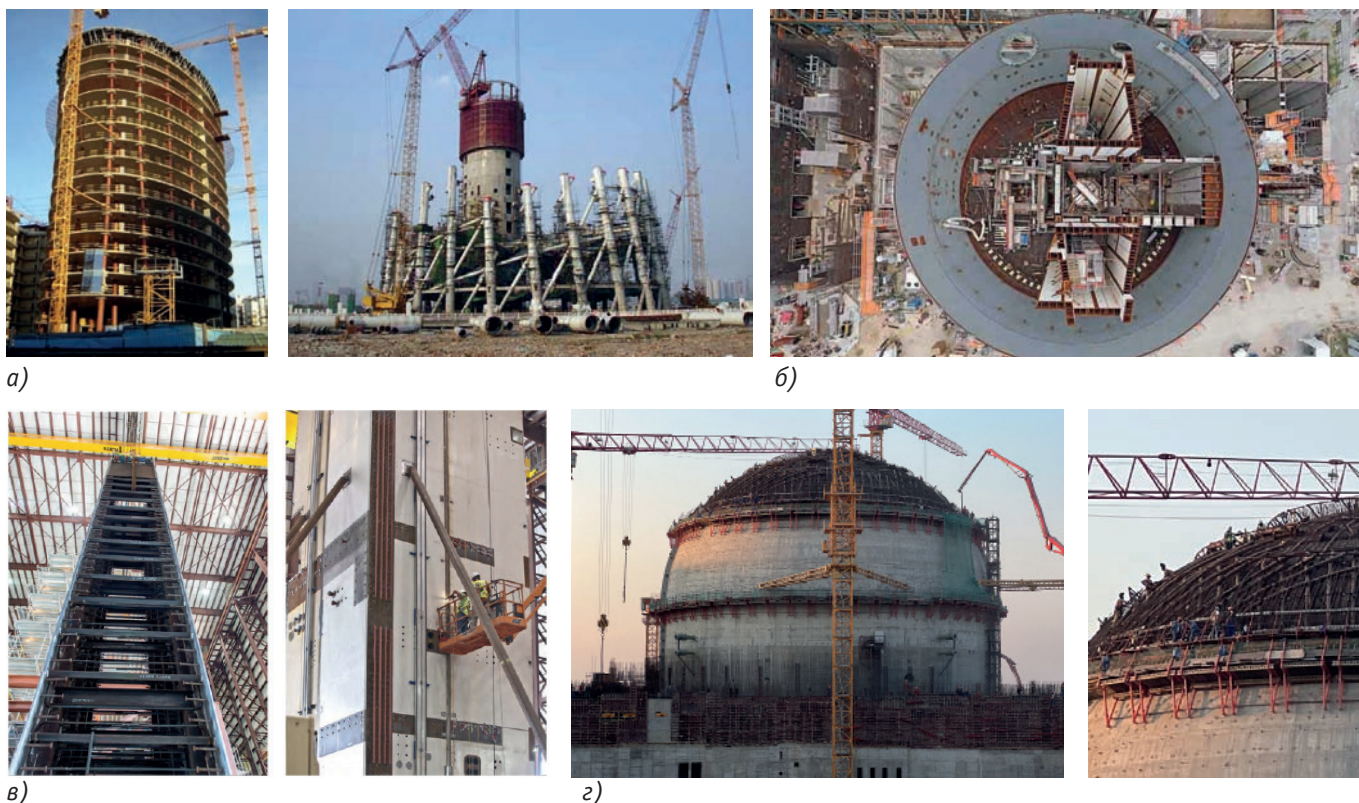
². Примеры, элементов конструкций с закрытой бетонной поверхностью для которых возможно использование разрабатываемого метода контроля сплошности бетона: а) использование трубобетонных конструкций в гражданском строительстве; б) стальной модуль стены с последующей заливкой бетоном. АЭС «Вогтль», блок № 3, 4. США. Дата окончания строительства – 2023 год; в) вид изнутри модуля сталежелезобетонной стены АЭС Саньмень. Китай. Дата постройки – 2018 год (источник: Design Guide 32: Modular Steel-Plate Composite Walls for Safety-Related Nuclear Facilities), г) устройство стальных труб системы предварительного напряжения в защитных атомных оболочках реакторного отделения. Фото авторов статьи
